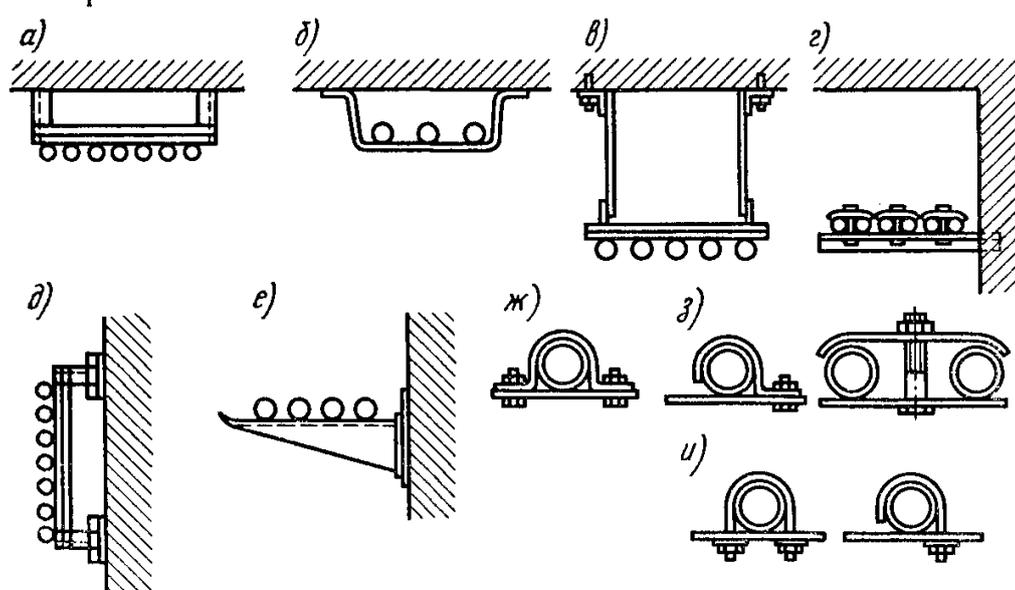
Опорные и крепежные конструкции и детали для трубных электропроводок: *а, б, в* - потолочные опорные конструкции из уголка, перфорированной полосы и на подвесках; *г, д, е* - настенные опорные конструкции и кронштейны; *ж, з, и* - хомуты, полухомуты, двухлапковые и однолапковые скобы и накладки для крепления труб к опорным конструкциям
